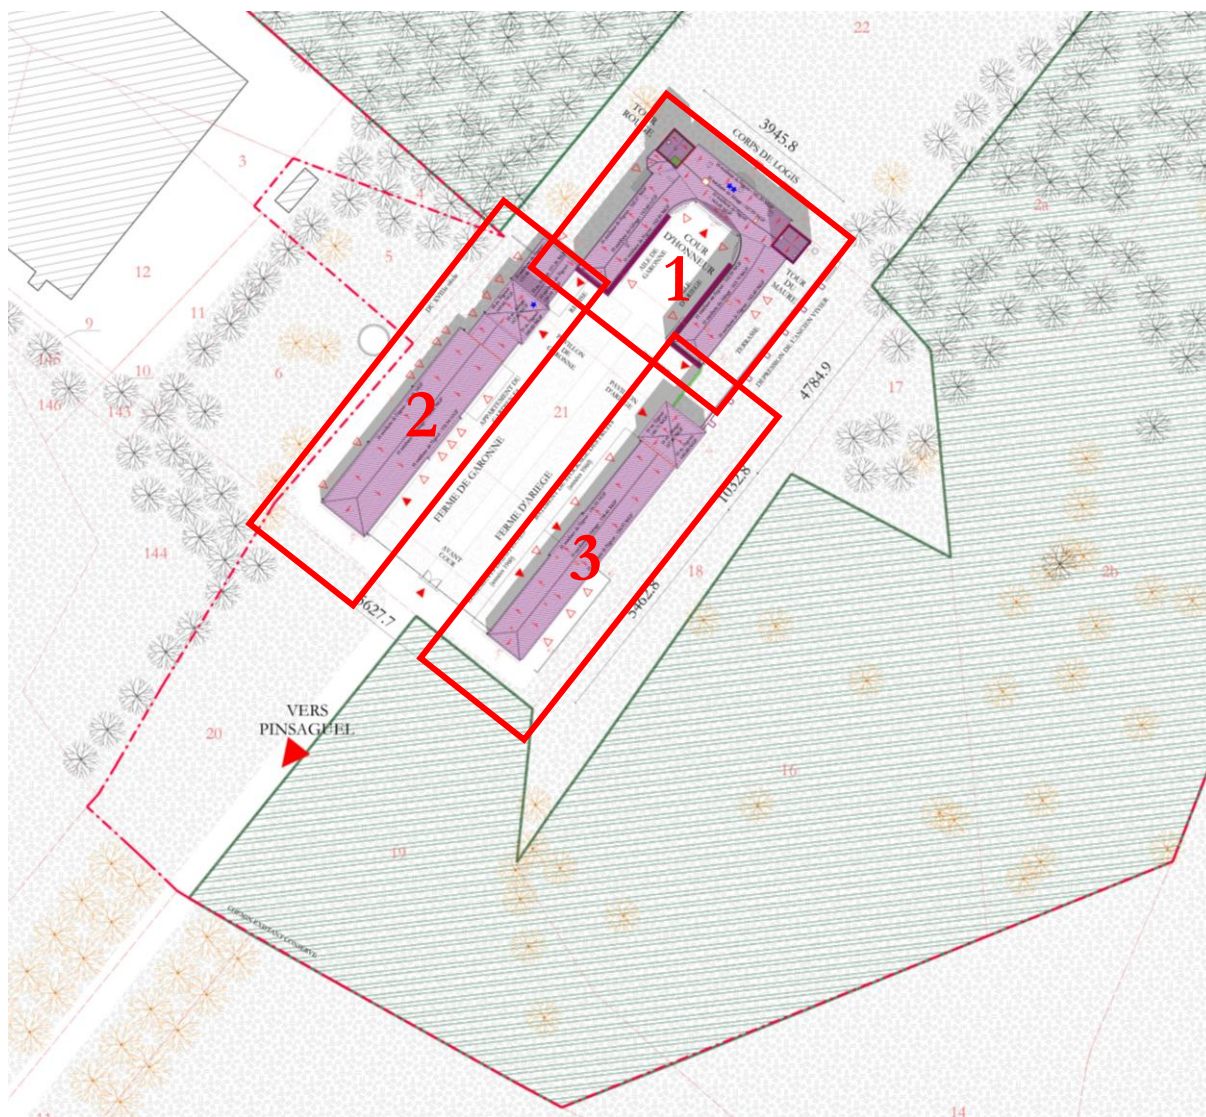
PLAN DE MASSE (ETAT EXISTANT)
